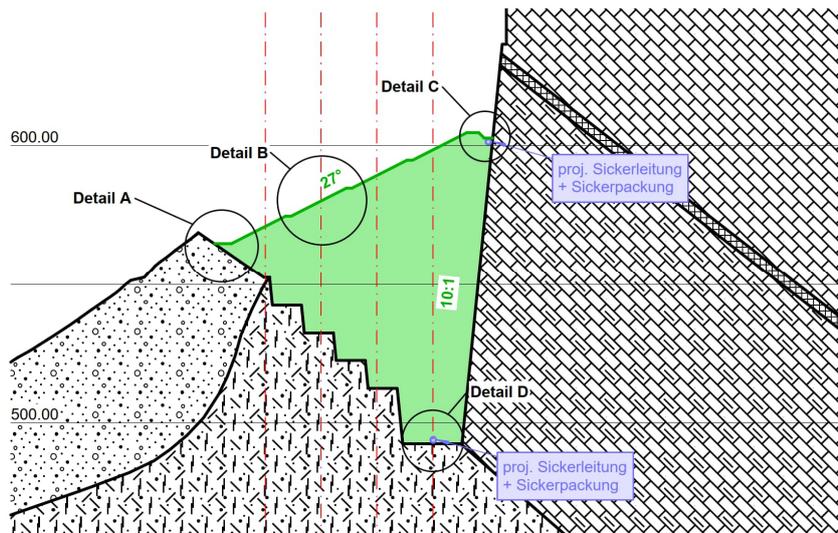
Ausschnitt Normalprofil Auffüllung mit den projektierten Sickerleitungen und Sickerpackungen
